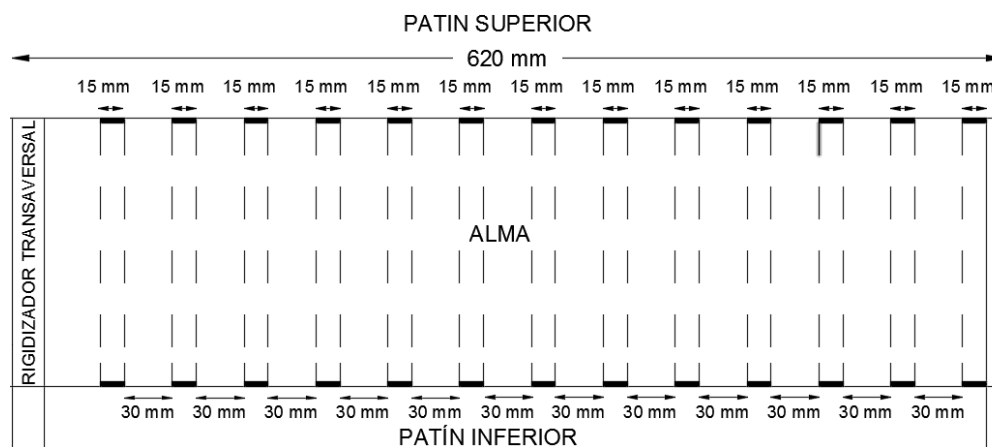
Cordón de soldadura entre el patín inferior y superior con el alma de la viga (Corte Longitudinal).
